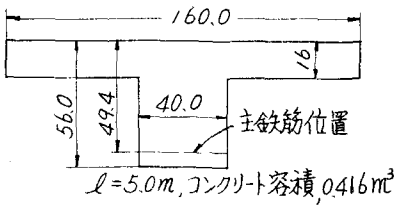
各スパンに対する鉄筋コンクリートスラブの経済的断面寸法と必要コンクリートの容積
